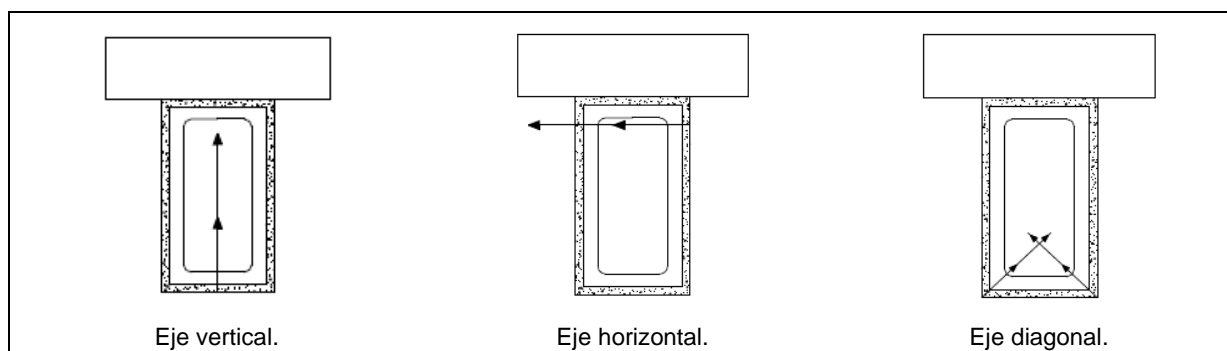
Dirección dentro de las vigas¹⁴.
